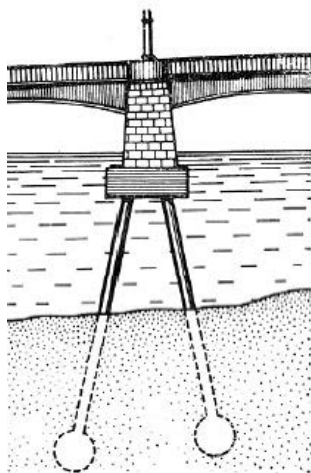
Конструкция опор моста: быки стоят на «ножках» в бетонных башмаках
